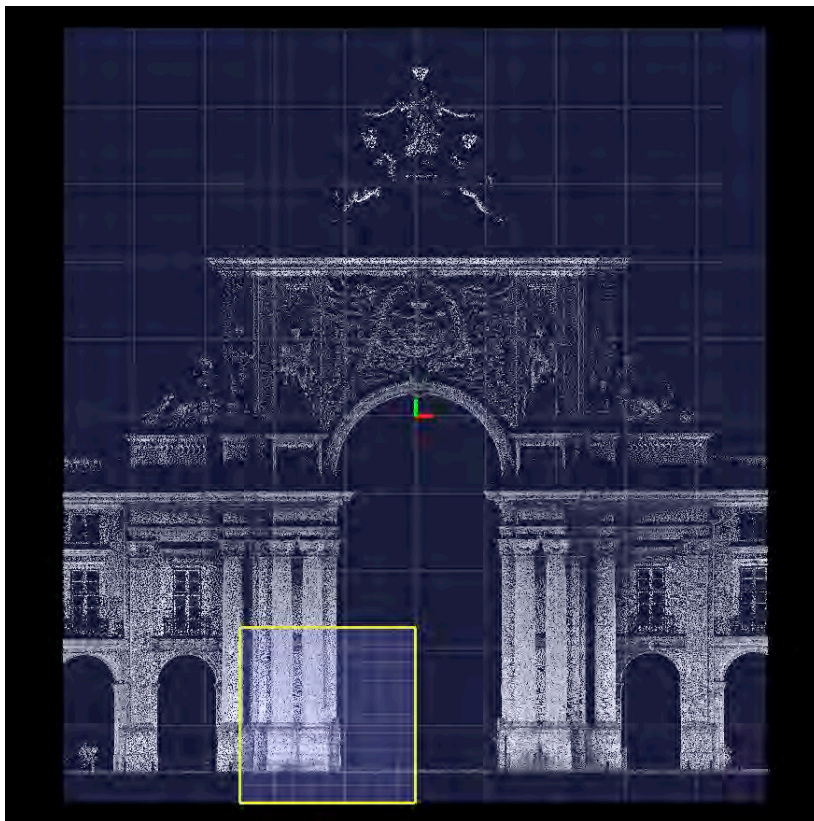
Una delle sedici sottoaree in cui è stato suddiviso il prospetto sud dell'Arco da Rua Augusta - piano ortogonale verticale.
